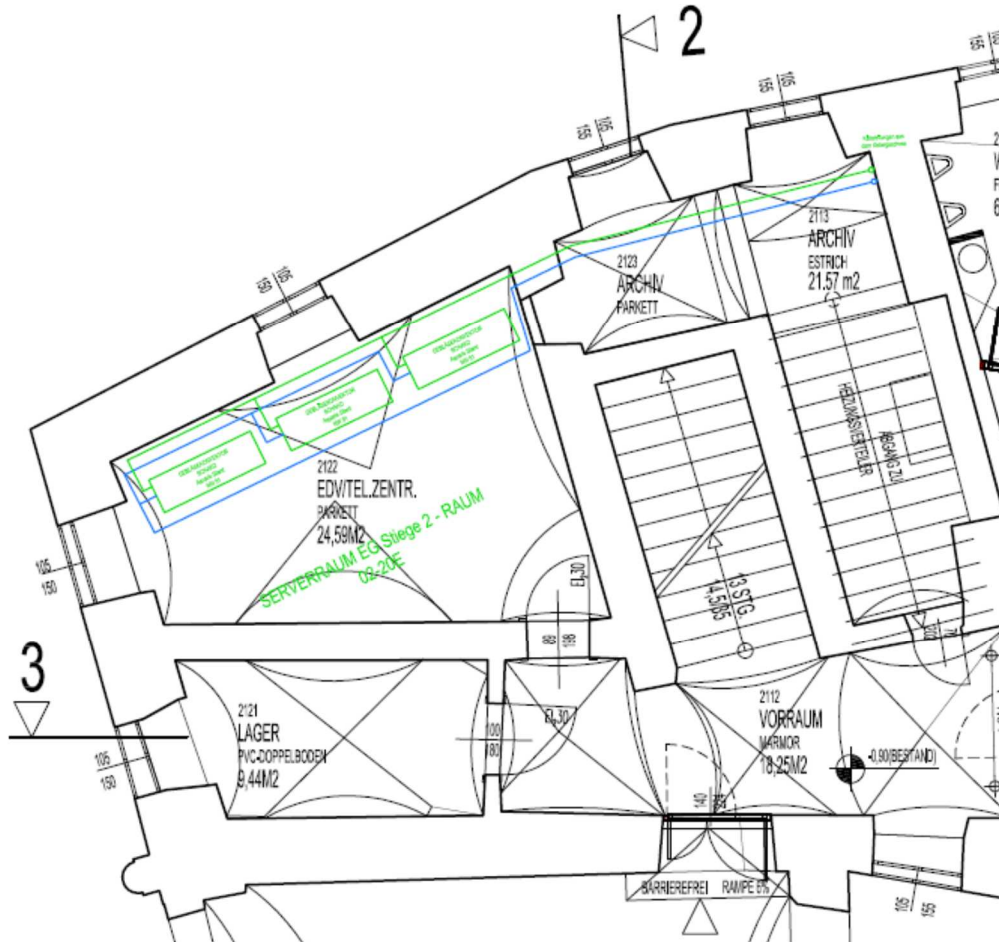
Grundrissausschnitt Erdgeschoss Serverraum 02-20E
